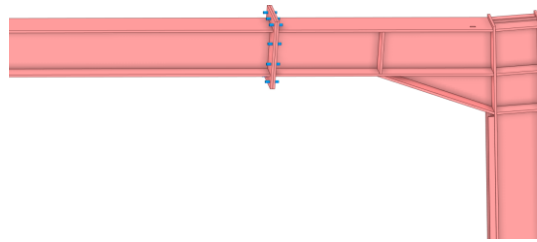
Detalle de unión atornillada pilar-viga de cubierta
